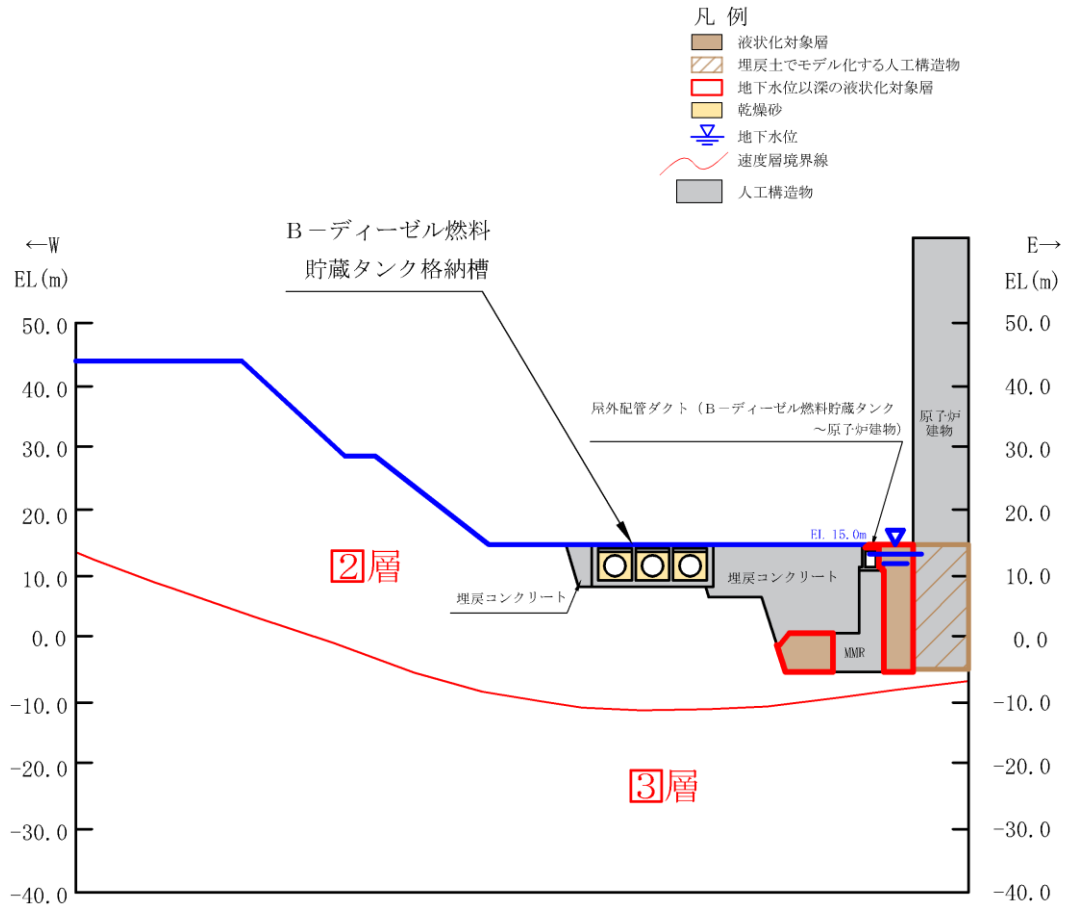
B-ディーゼル燃料貯蔵タンク格納槽 地質断面図 (A-A断面位置)
